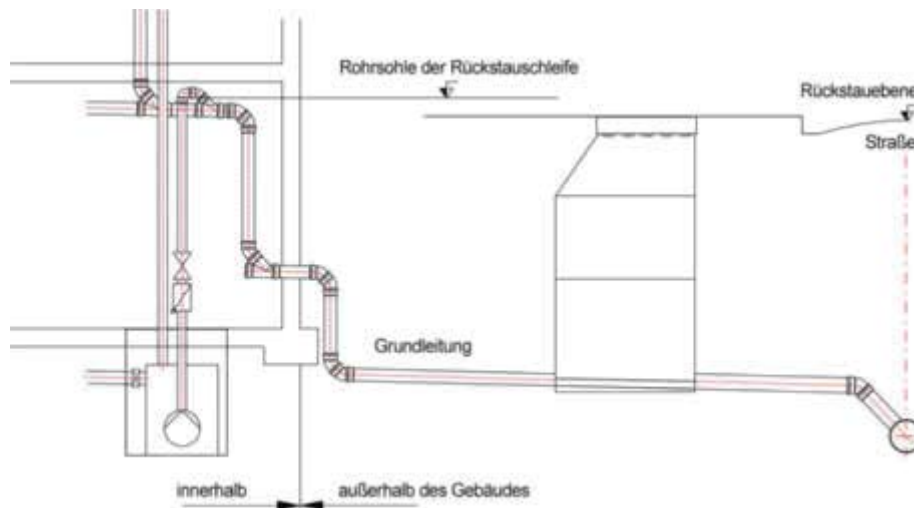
Rückstauschleife einer Abwasserhebeanlage
